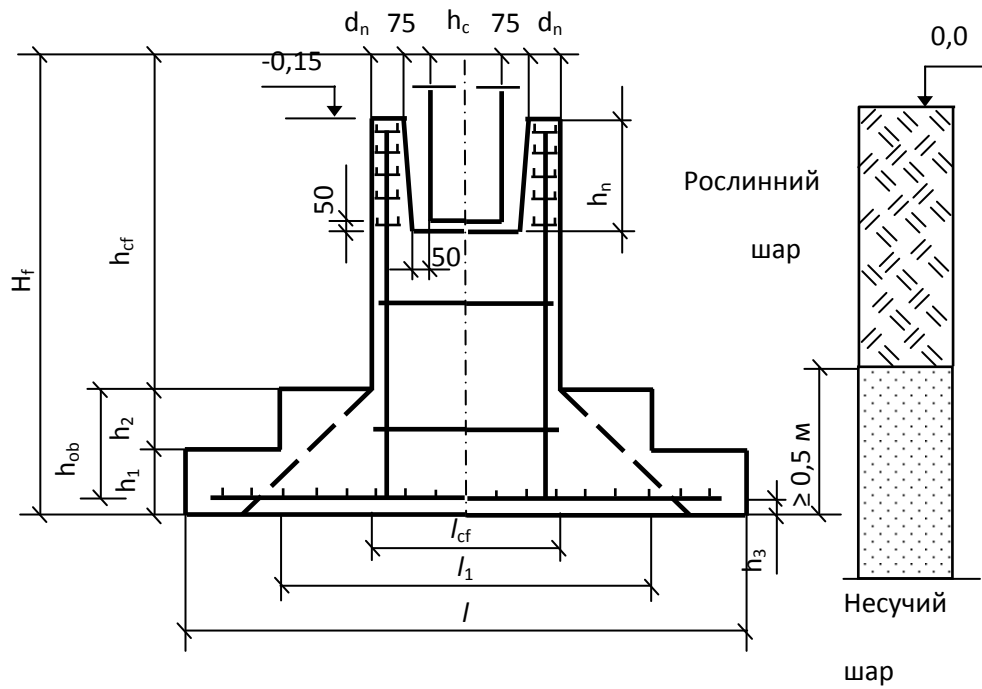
Конструкція фундаменту під збірну колону з підколонником
